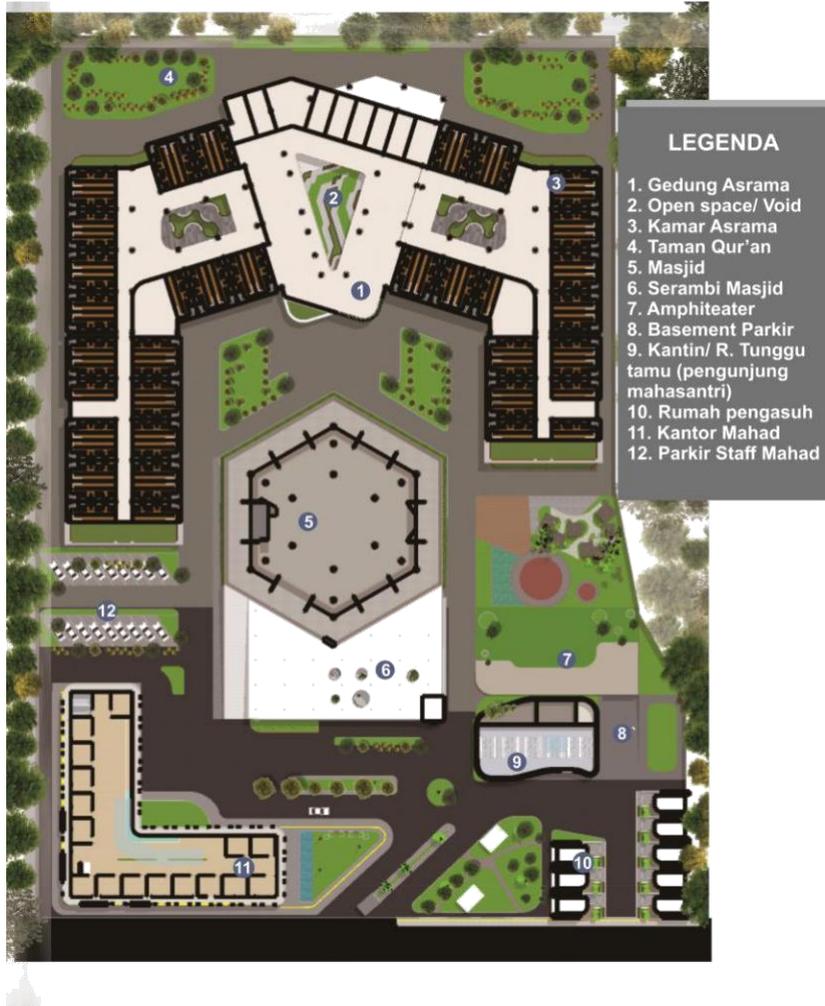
1 Site Plan Mahad Putri Kampus 3
